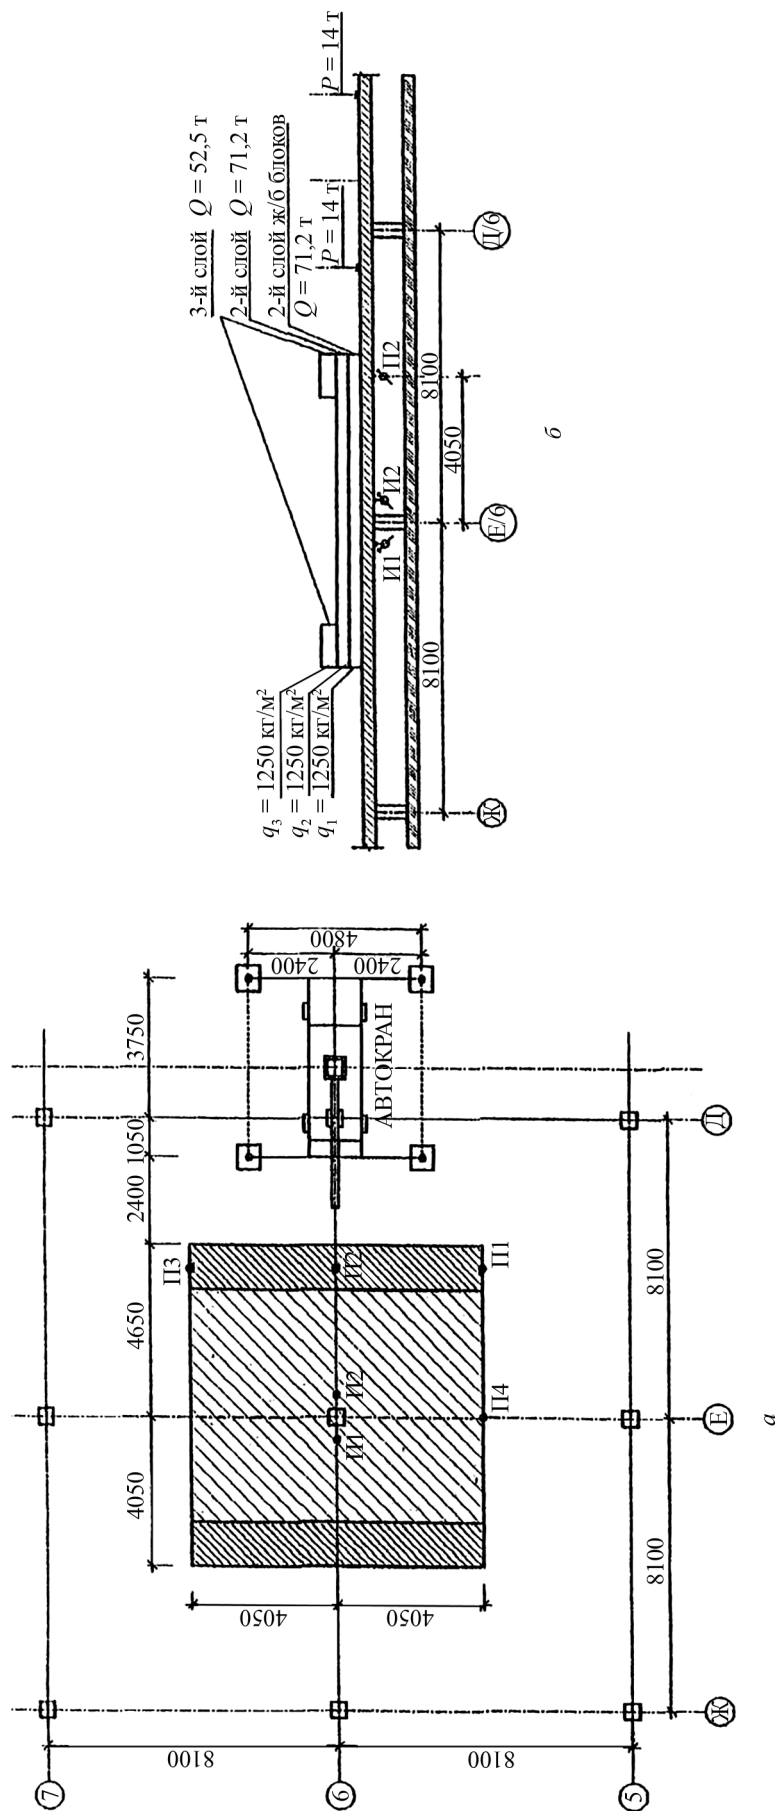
Схема приложения нагрузок в натурном испытании узла опирания монолитной плиты покрытия подземного гаража: а — план; б — разрез по оси 6; И1 и И2 — индикаторы, фиксирующие смещение плиты покрытия рядом с колонной; П — прогибомеры.
